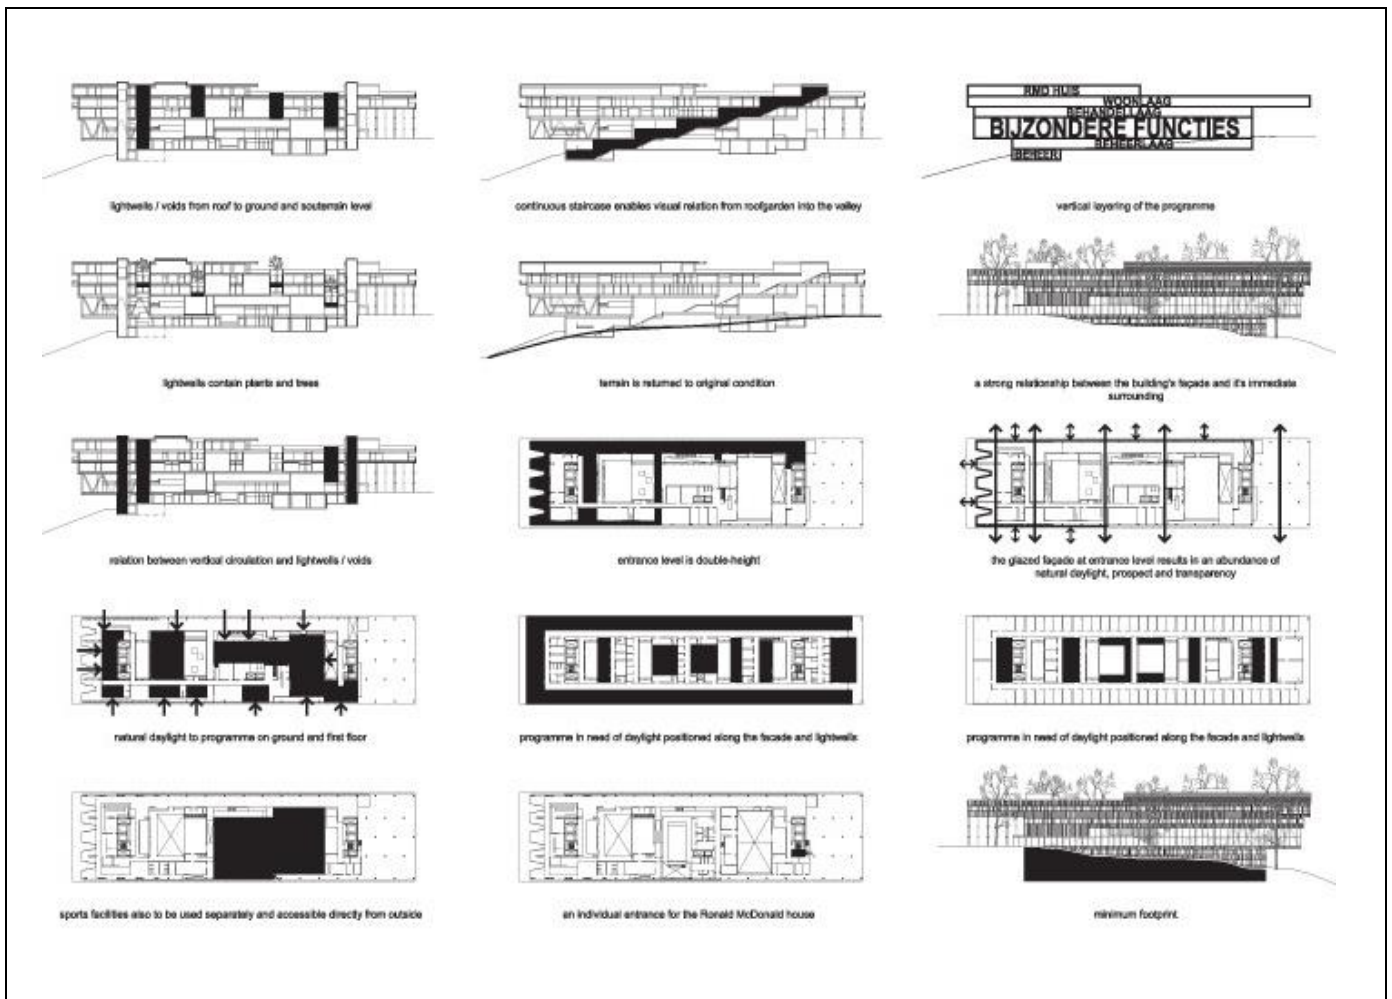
Розрізи та планування клініки Groot Klimmendaal
